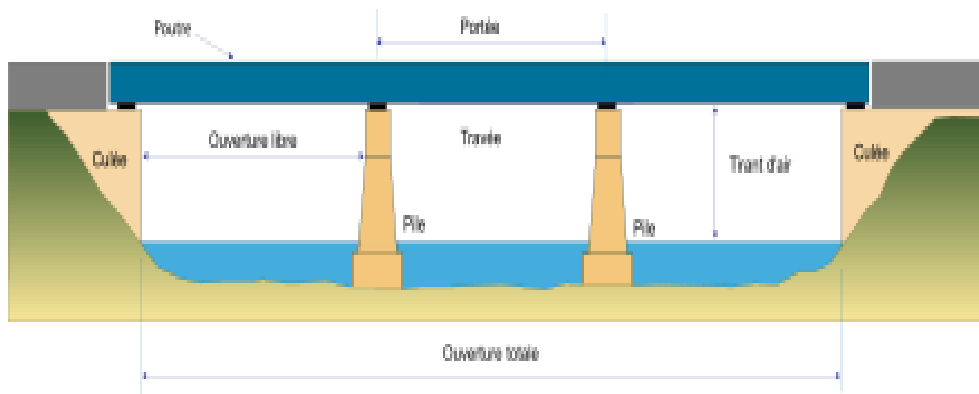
Schéma d'un Pont (vue longitudinale)
